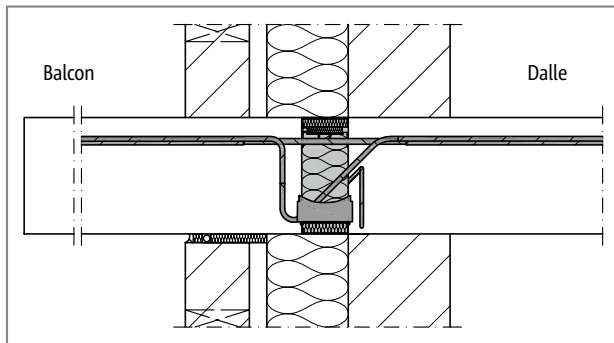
Schöck Isokorb® T Type K-E, K-T : Raccordement avec isolation du noyau
